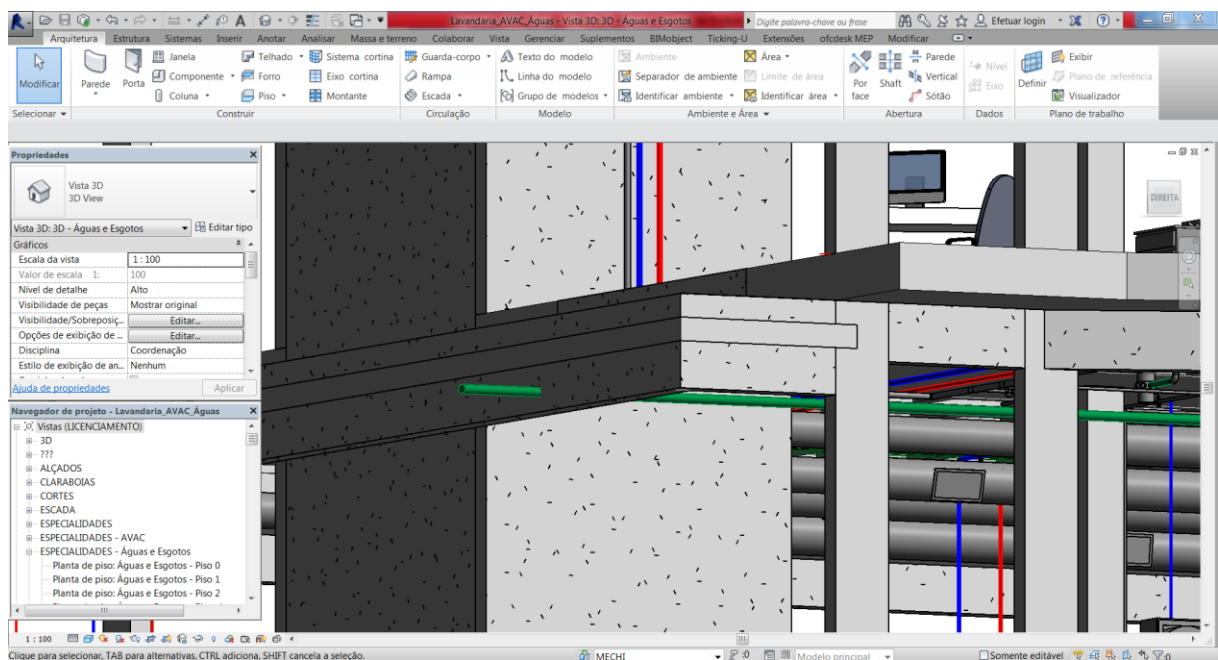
Colisão de elementos, entre uma viga e de um tubo de esgoto.
